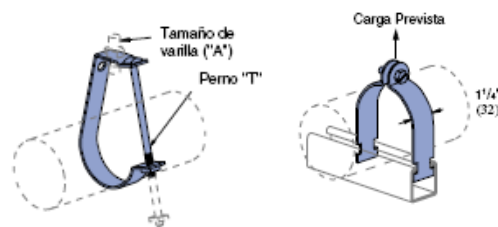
Soportería para tuberías tipo “pera” y “strut”.
